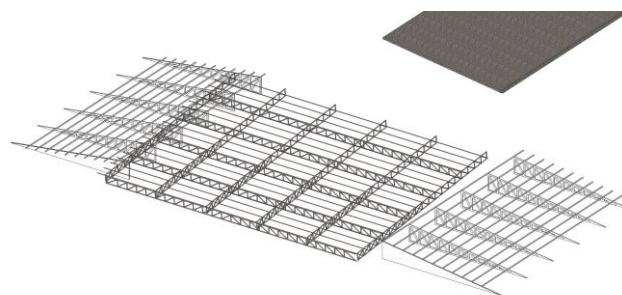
Sistem struktur rangka konstruksi beton.
